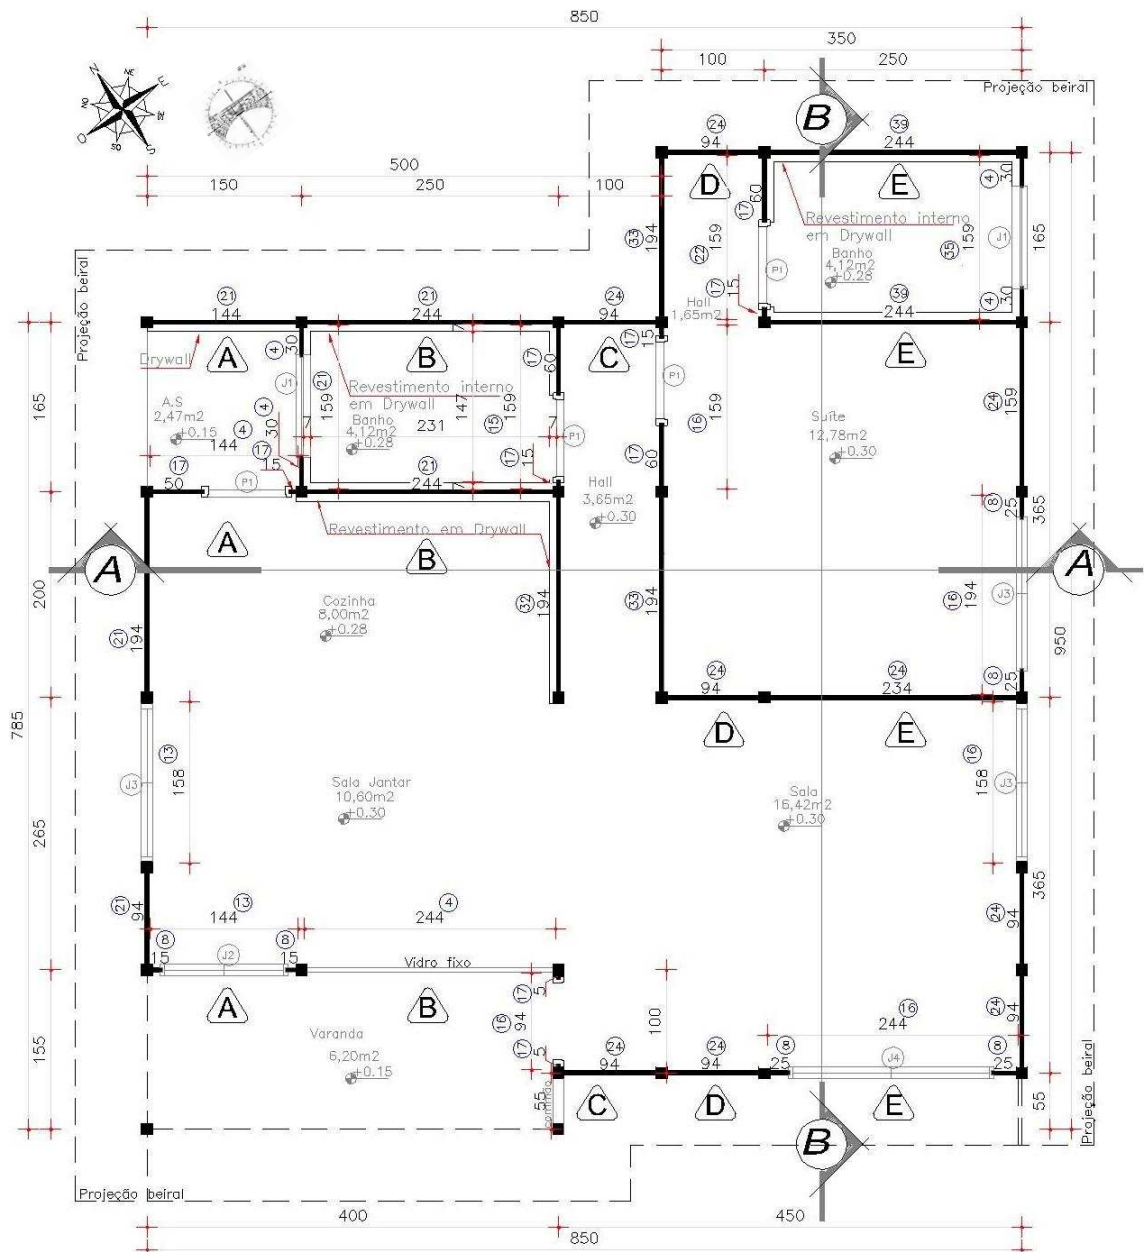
Projeto de montagem das paredes de vedação com encaixe macho e fêmea (módulo base).
